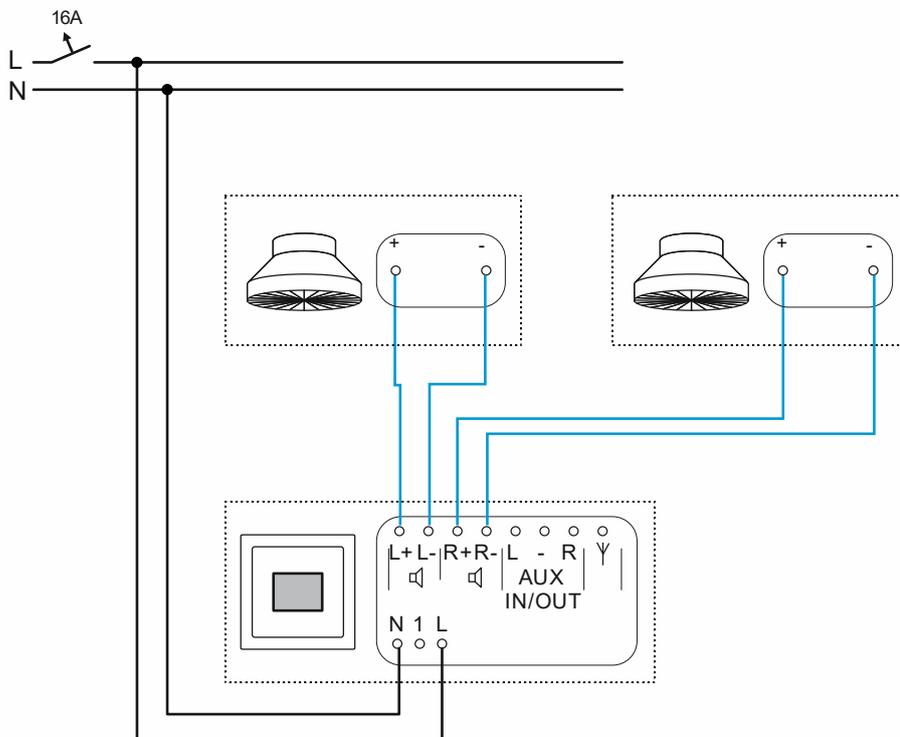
Radio encastrée avec 2 haut-parleurs au plafond : raccordement
